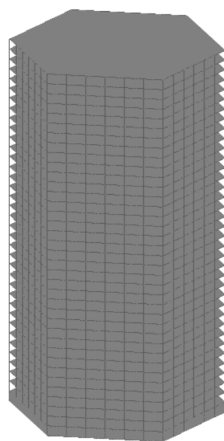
Расчетная схема здания в ПК SCAD
